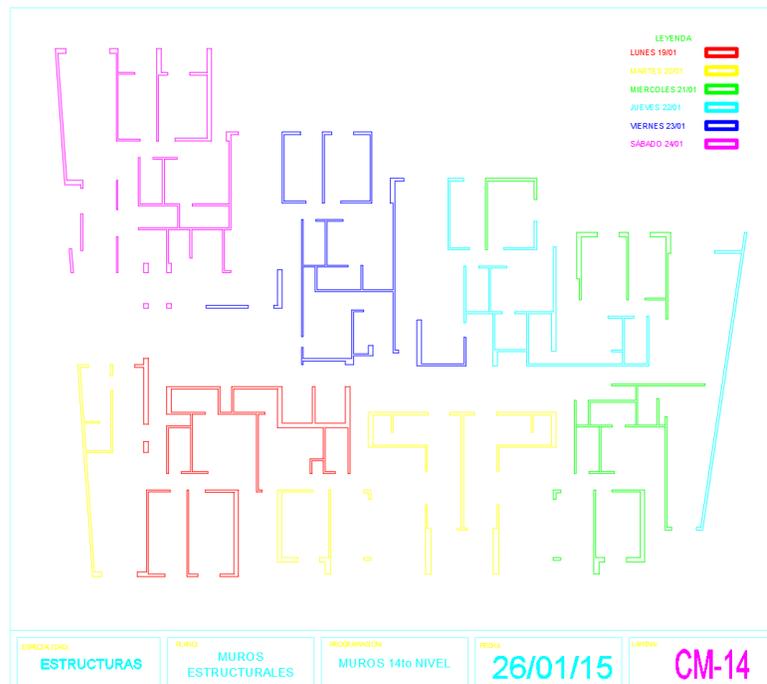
Sectorización de Muros Nivel 14. Fuente: Elaboración Propia
